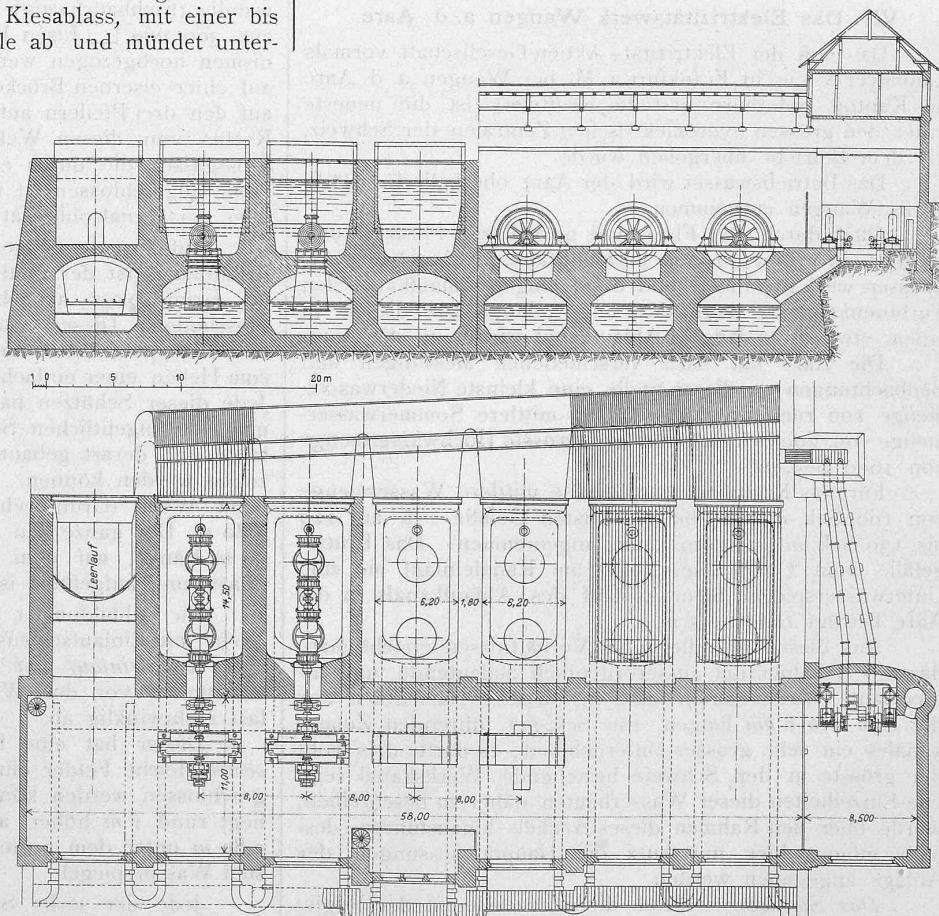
Das Maschinenhaus. — Grundriss und Längsschnitt. — Maßstab 1 : 500.
